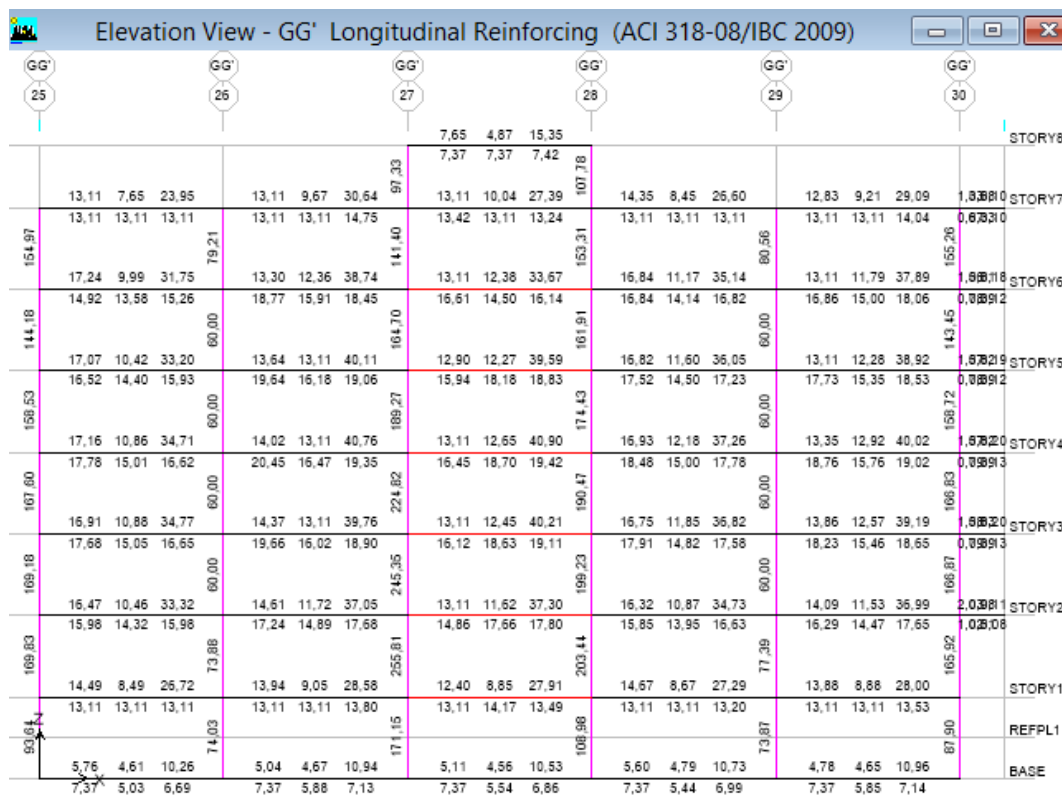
Acero en Vigas y Columnas en el Pórtico GG – Hospitalización 2- (LRB+HDR)
